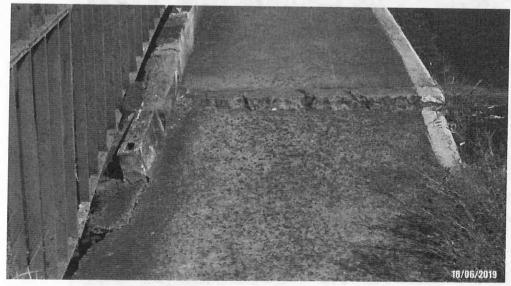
Detalhe da mureta de fixação do guarda corpo rompida.
